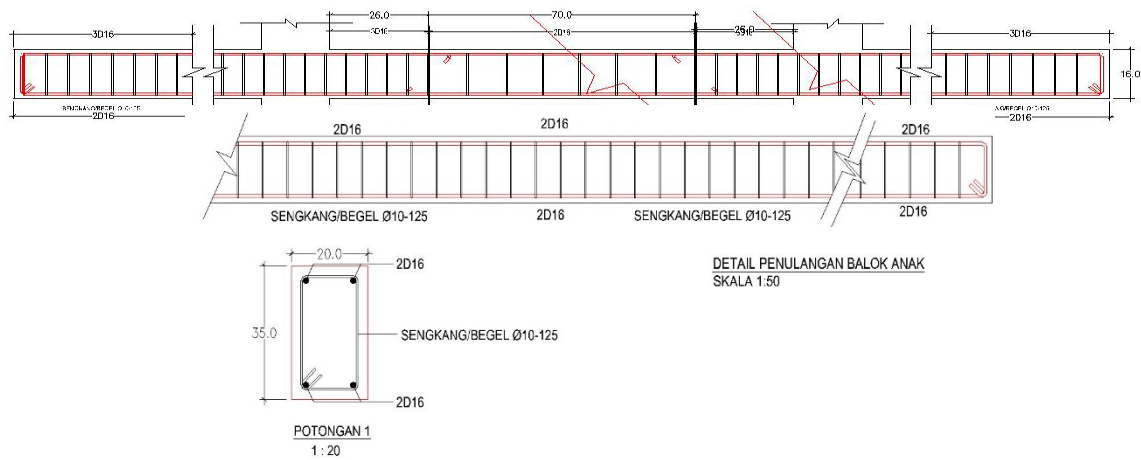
Penulangan Balok arah Y Lantai 2 & 3
